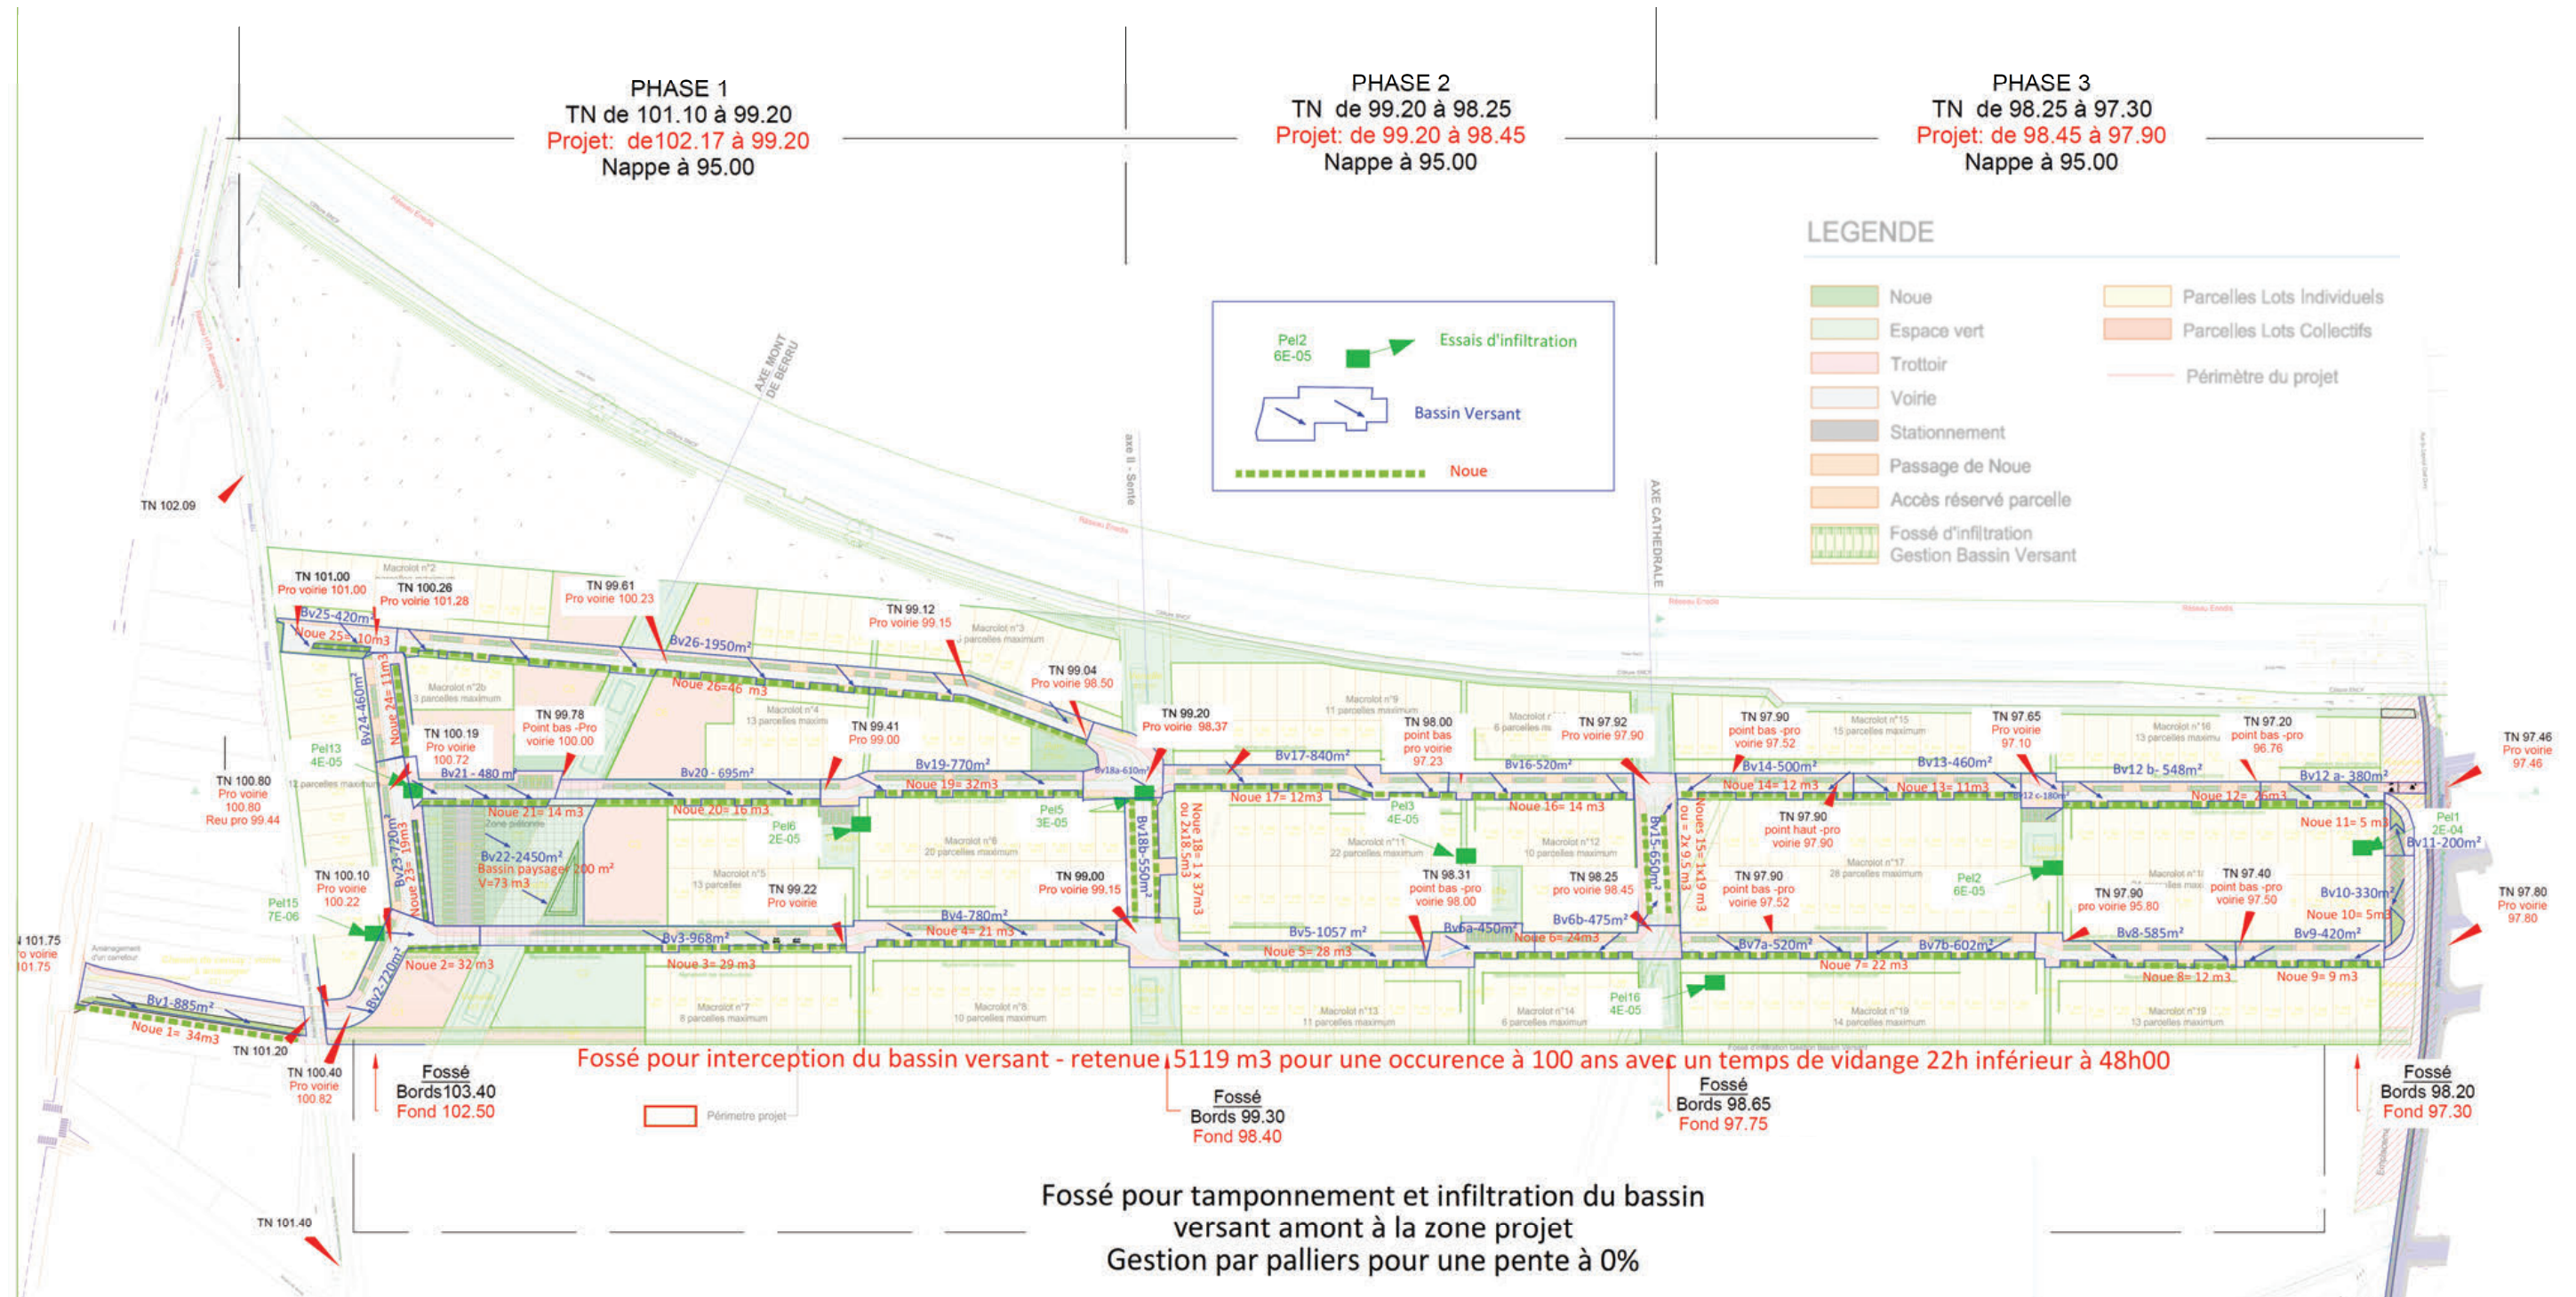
Plan de gestion des eaux pluviales (VRD Partenaire)
